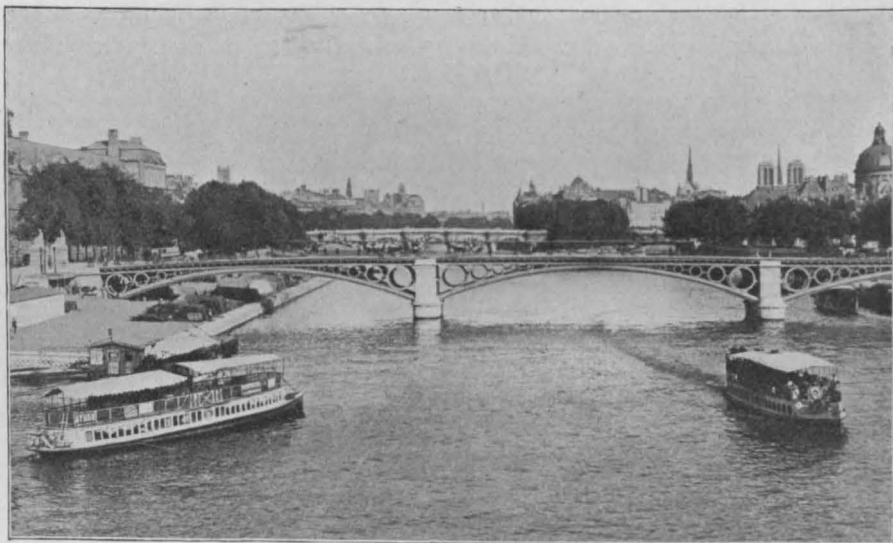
Carousselbrücke in Paris. Im Hintergrunde Pont Royal. 1831—1834.
